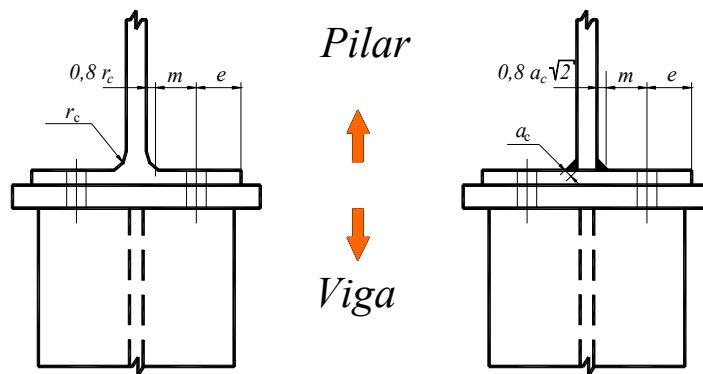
Dimensões m e e para determinação da resistência à flexão da mesa do pilar (perfil laminado e perfil soldado)
